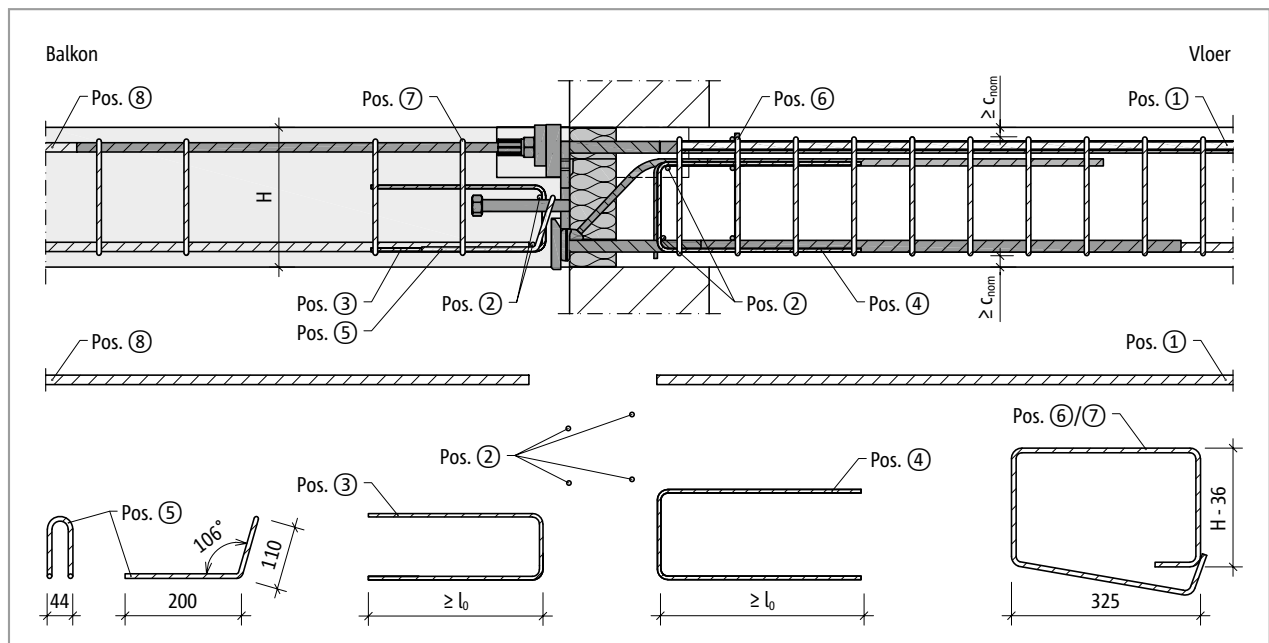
Schöck Isokorb® T type K-IQ-A-CB: Bijlegwapening
